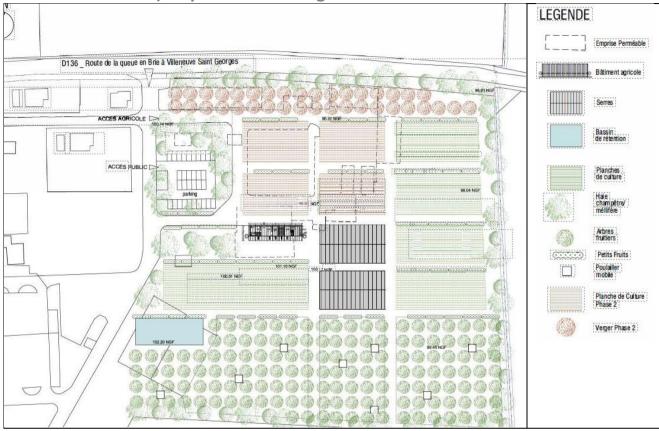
plan d'implantation général au 1/1000ème de la ferme (Source : Architecte Sonia Cortesse ADSC)
